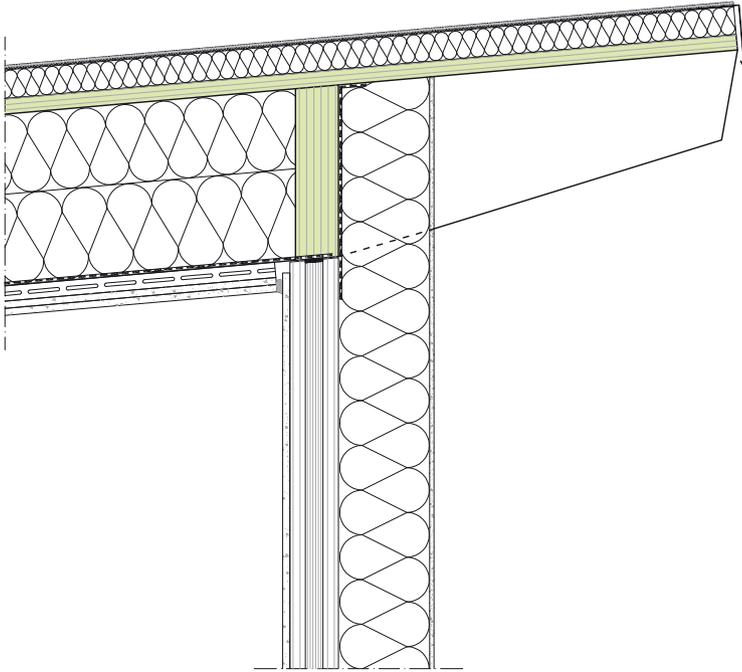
DETAIL: DACHDURCHBRUCH KERTO-RIPPENELEMENT
